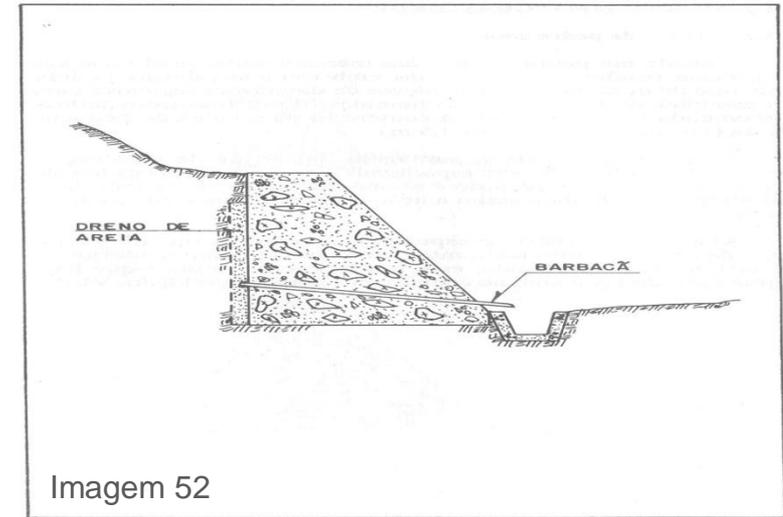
Muro tipo “gravidade” de concreto ciclópico
